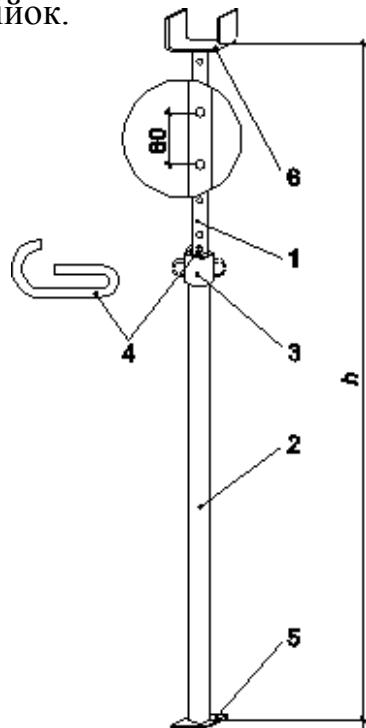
Конструкція телескопічної стійки: 1 – верхня висувна частина стійки; 2 – нижня частина стійки; 3 – регулювальна муфта; 4 – фіксуюча скоба; 5 – опорна п'ята; 6 – оголовок
